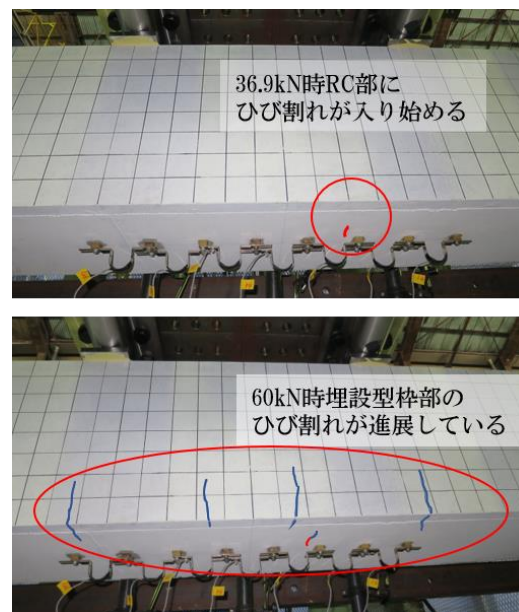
各载荷時点におけるひび割れ状況 (ケース 3)
